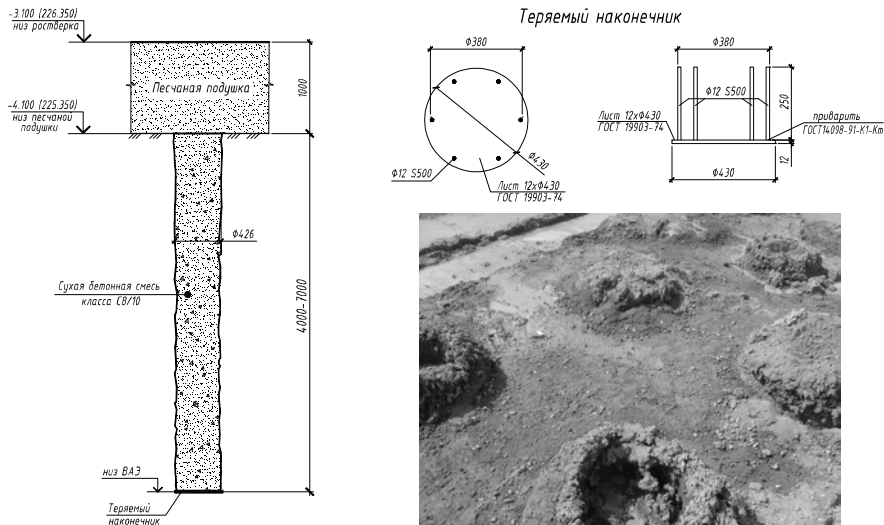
Вертикальный армирующий элемент из сухой бетонной смеси в выштампованной скважине
